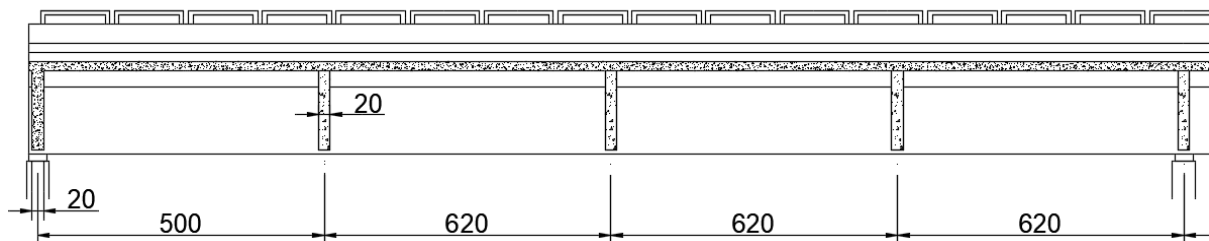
Corte longitudinal de meia seção da ponte 2 (dimensões em cm)
